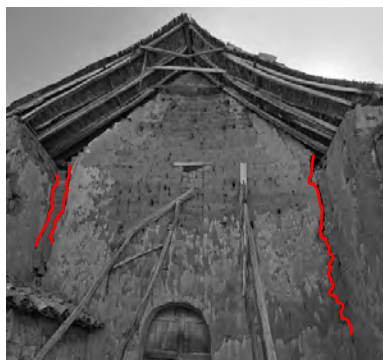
Contrafuerte añadido en el muro de pies (b)
